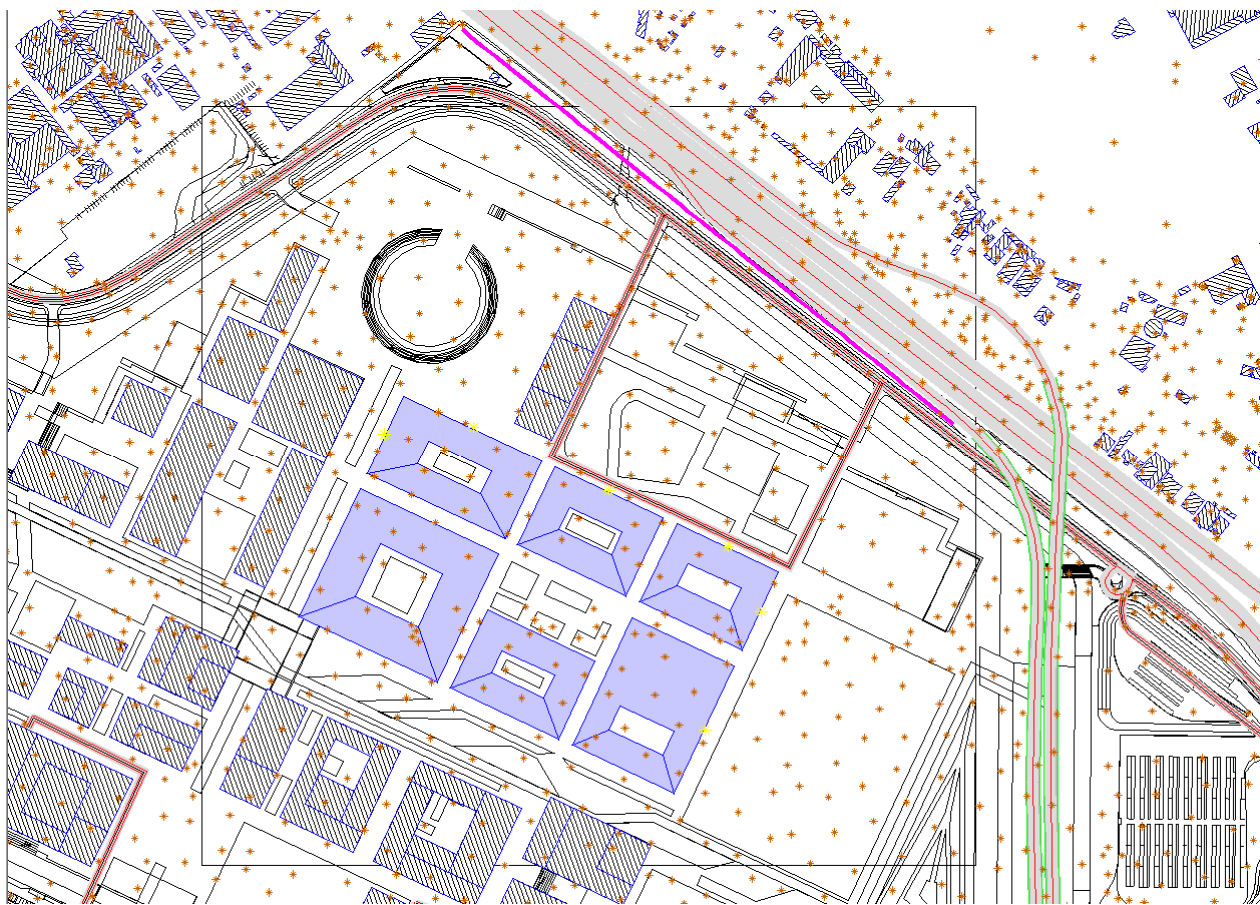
Disposizione planimetrica della barriera ottimizzata lungo l'A8 (linea viola)
